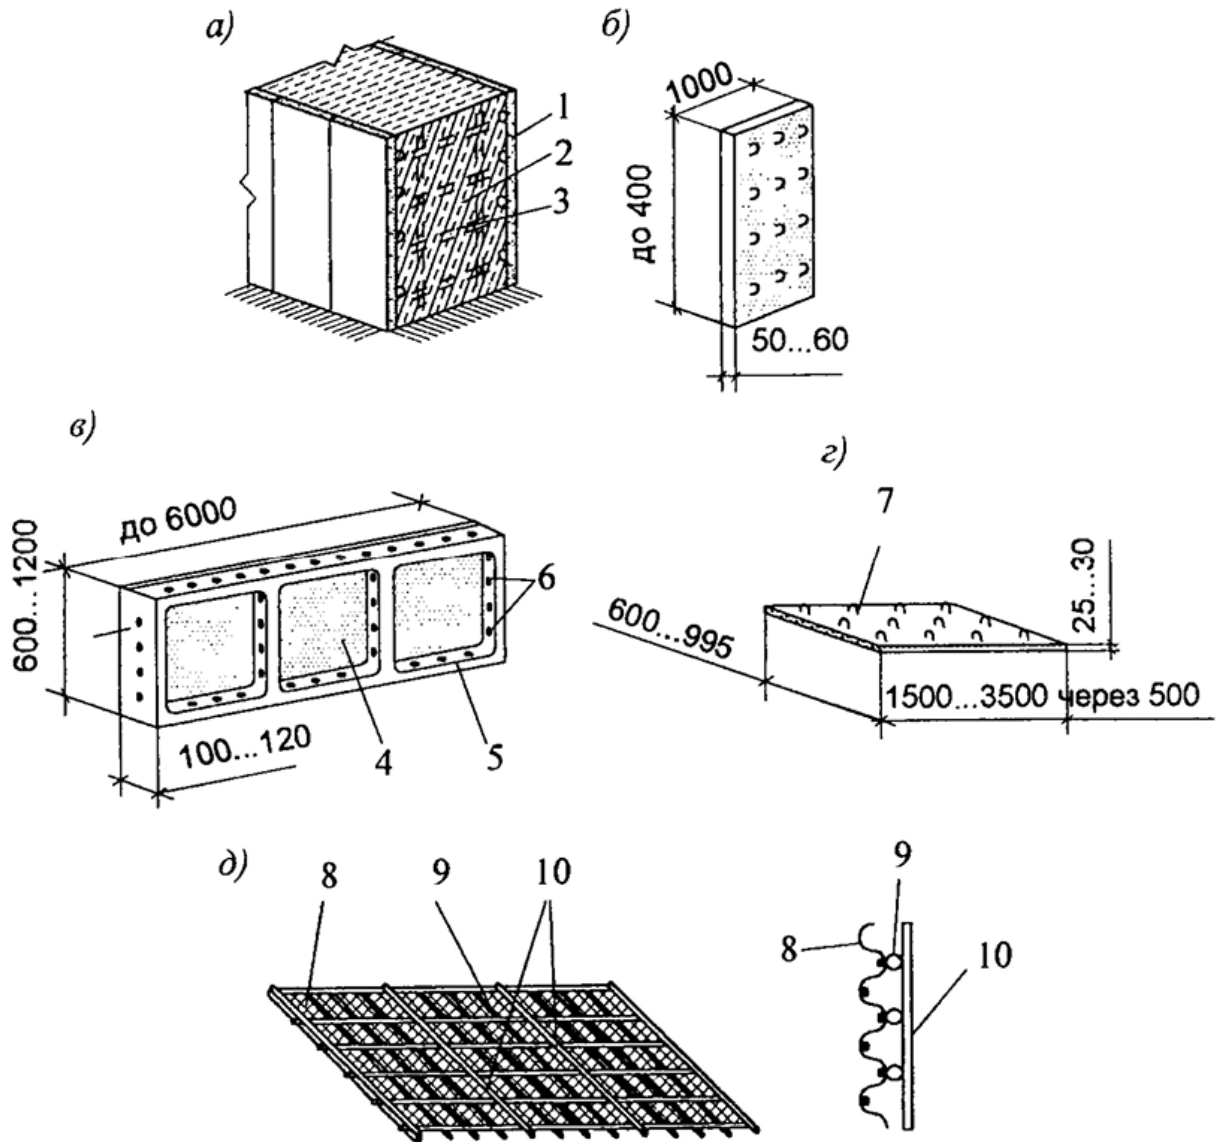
Незнімна опалубка з залізобетонних елементів:
